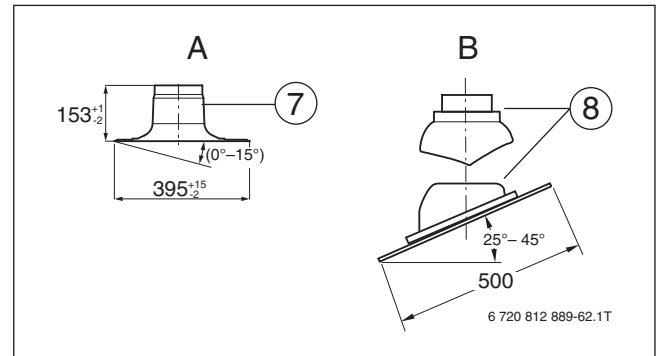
Universaldachpfannen und Flachdach-Klebeflansch als Zusatzausstattung für den Grundbausatz DO (unbedingt mitbestellen); (Maße in mm)
